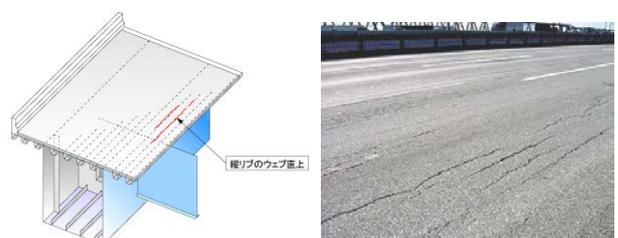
Uリブの溶接位置に沿った舗装ひび割れ
